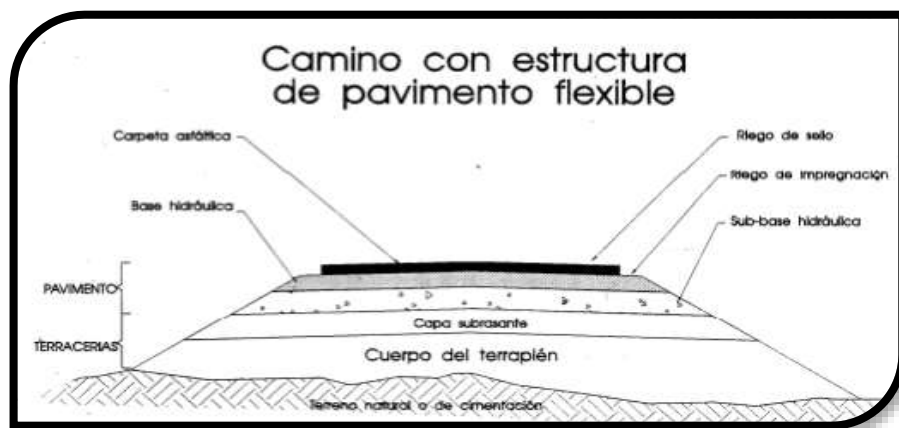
ESTRUCTURA DE PAVIMENTO FLEXIBLE
